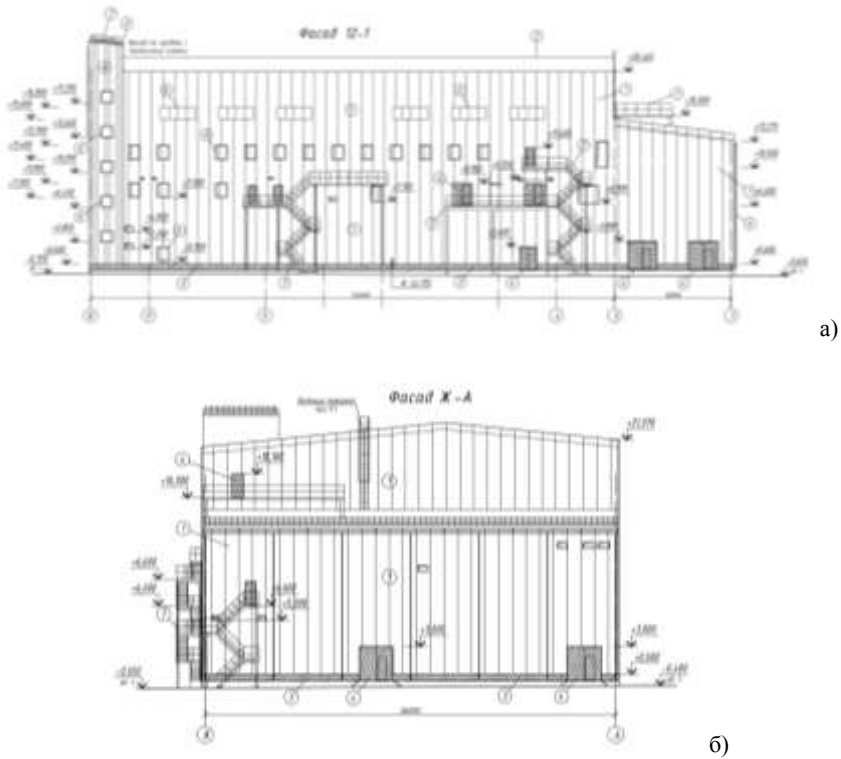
Фронтальний (а) та боковий (б) фасади будівлі фільтрувальної станції
